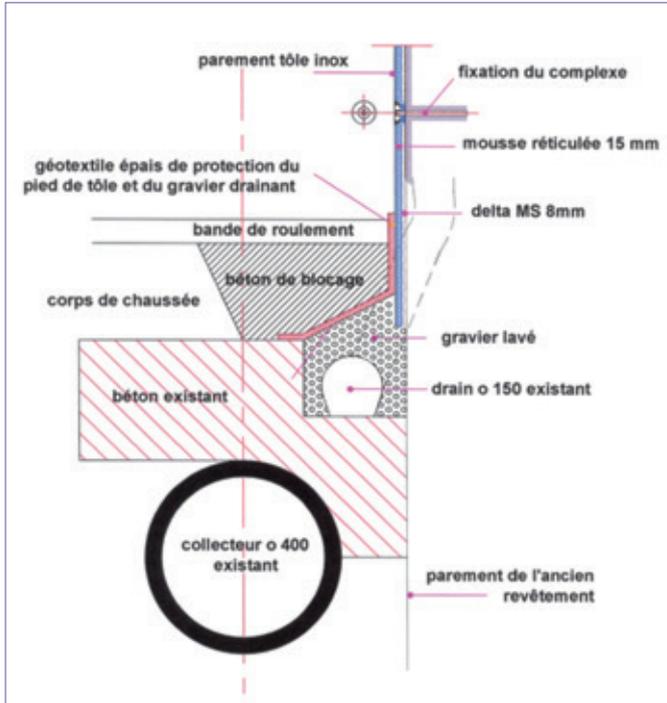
Exemple de drainage en base de piédroit dans le tunnel de Marquaires dans une zone de parement drainant (noter l'absence de trottoir dans cette zone, particularité liée à l'exiguïté du tunnel existant)
